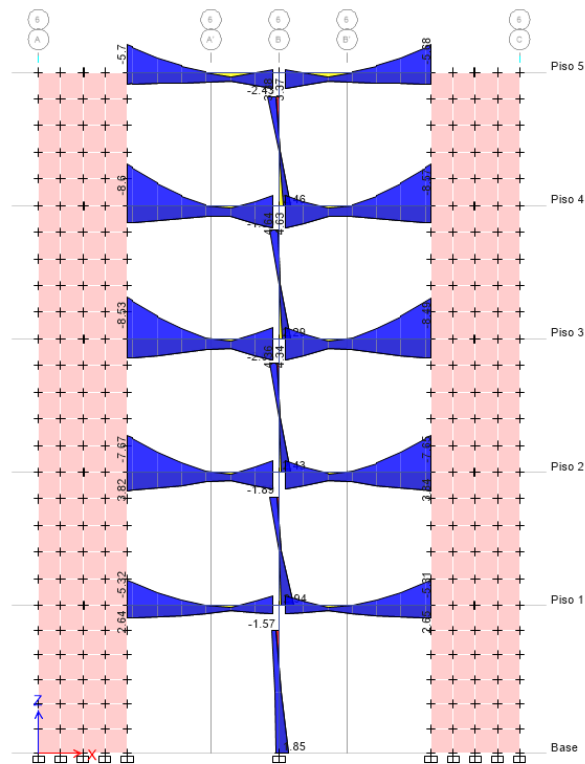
Vista en elevación de la VP2 0.25 x 0.50
